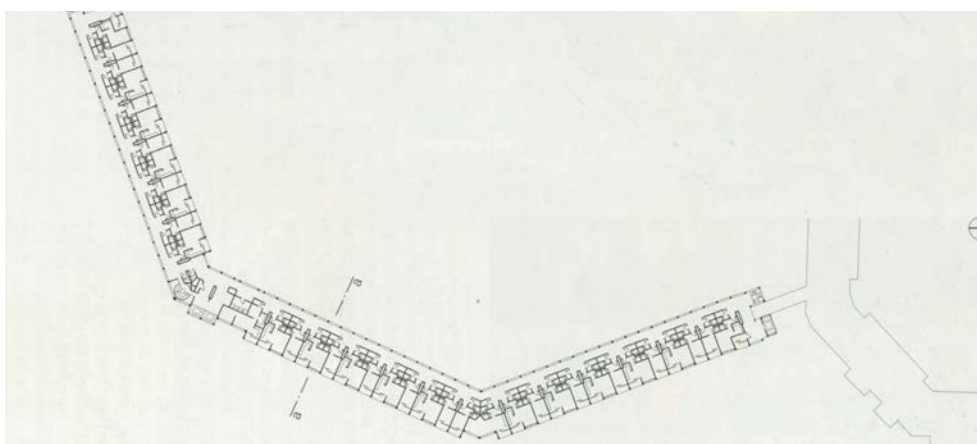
Planta de uno de los bloques reformados. En Detail en 2013.
